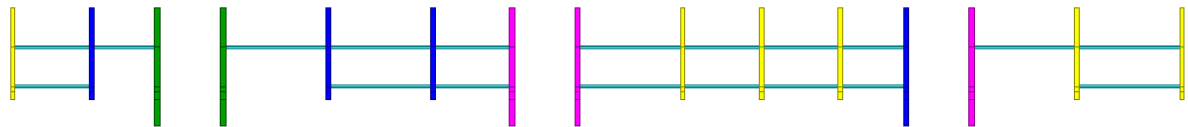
Prospetto della barriera 4.50m - tratto ovest da M01 a M15
